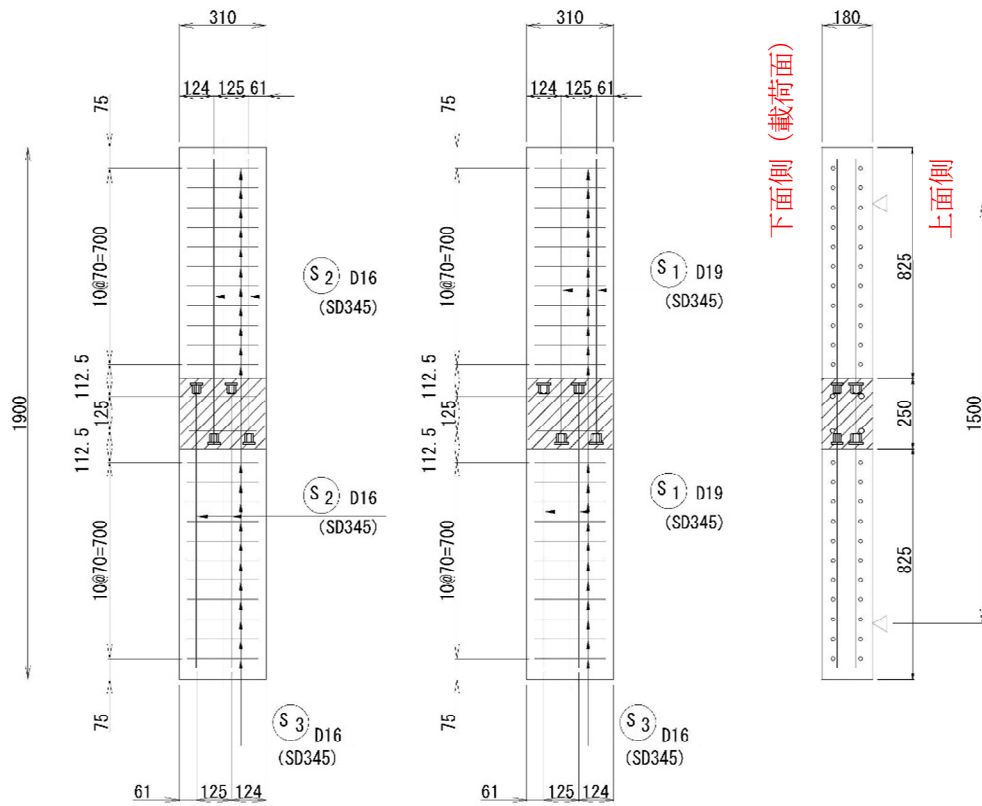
供試体 S1 の形状寸法 (単位 : mm)
